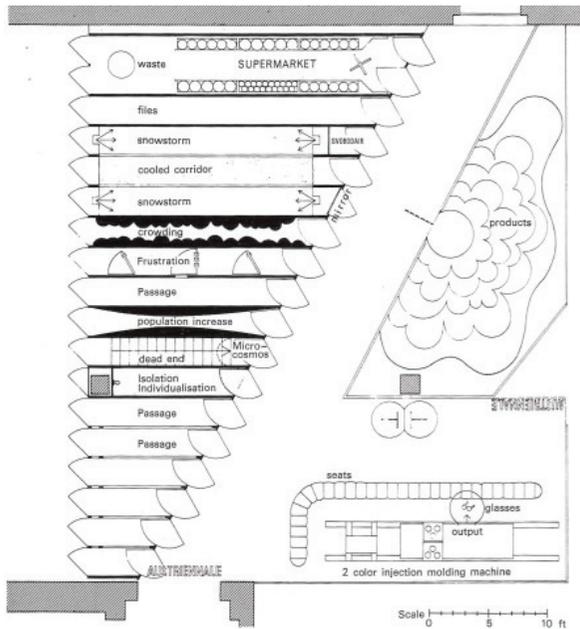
Plan Pavillon Austriennale - Mailand, 1968, Hans Hollein
